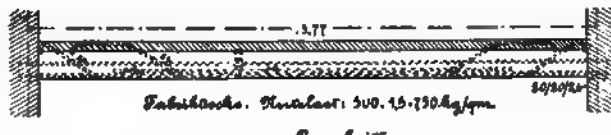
u. 268. Quer- und Längenschnitt einer Decke nach System Leschinsky.
